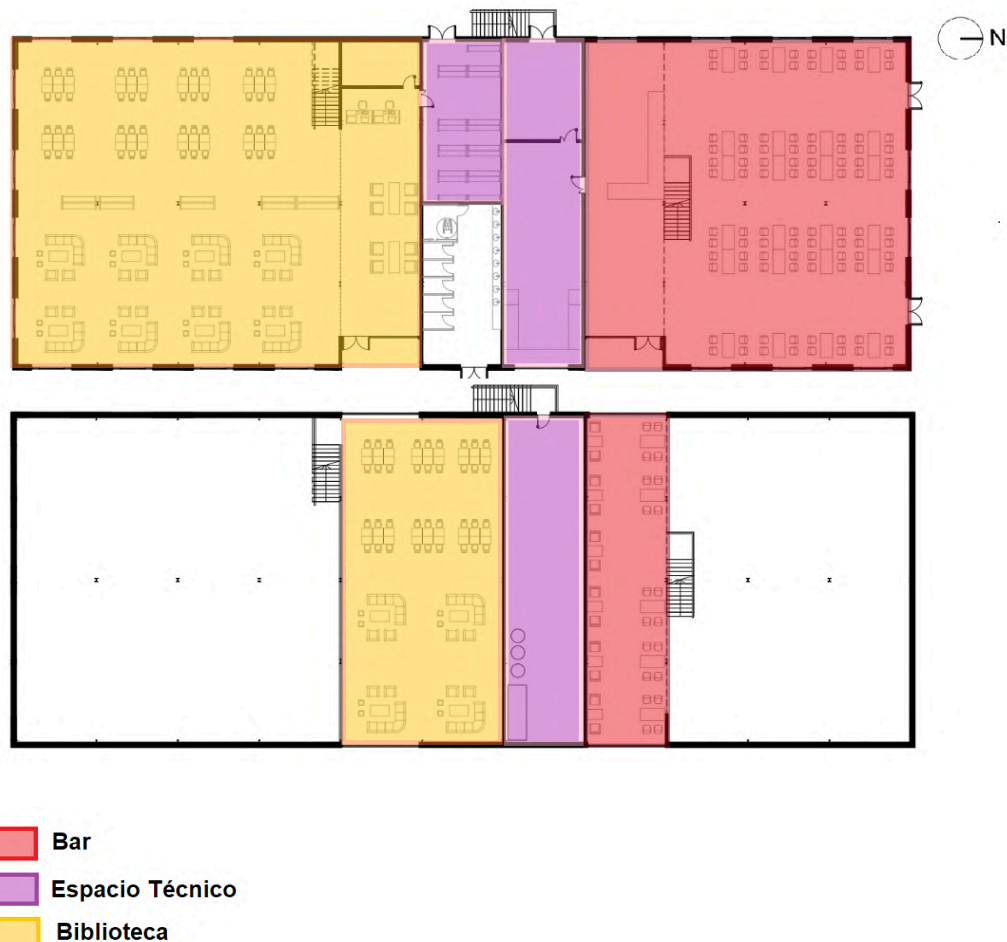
Edificio oeste: planta baja y planta alta, respectivamente (Biblioteca). Fuente: Elaboración propia.
